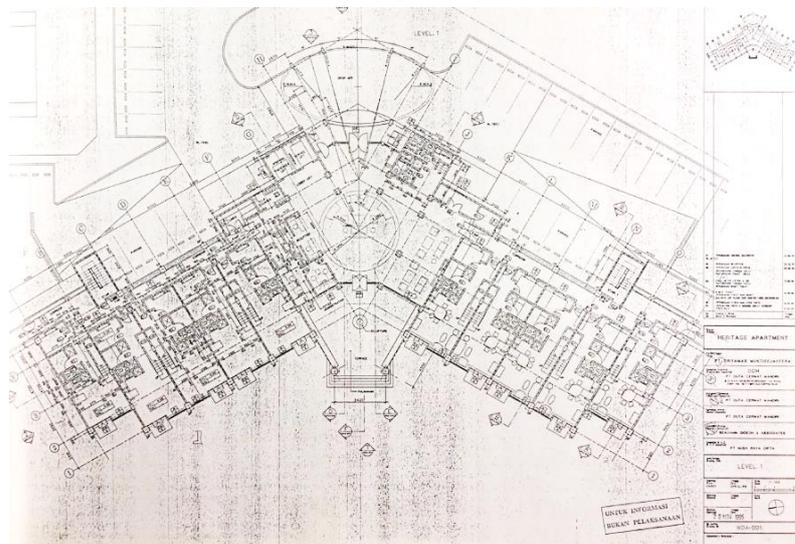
Denah Bangunan 3 Lantai (Hotel Novotel Suite, 2020)
